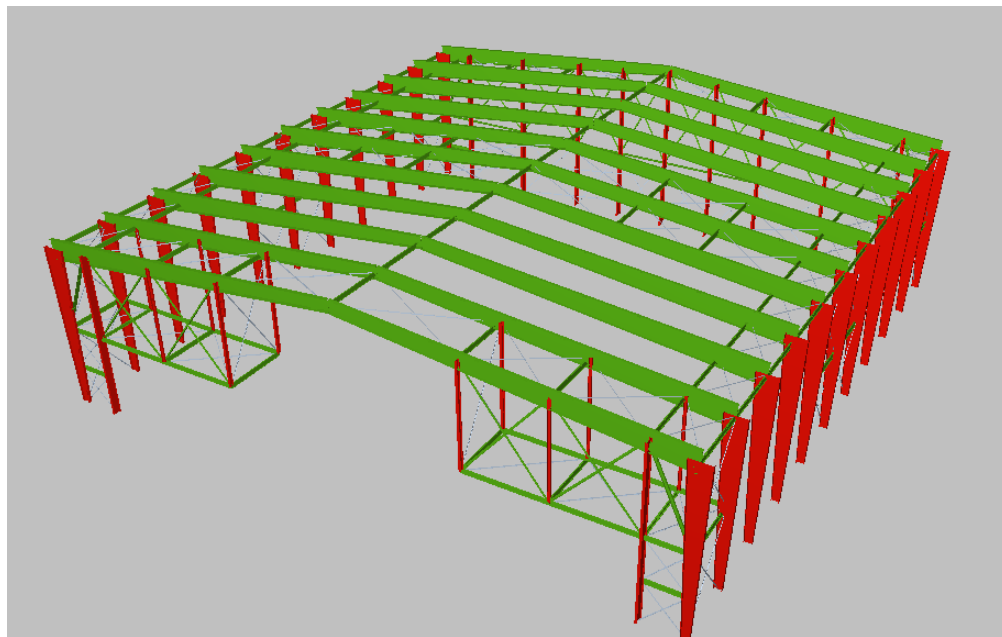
Vista en 3D de la parte delantera de la estructura metálica final del hangar en CYPE 3D.
